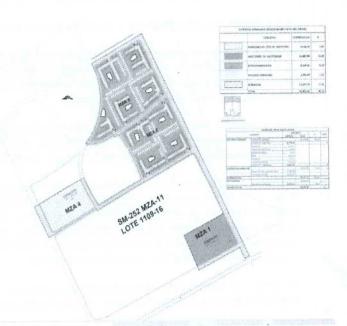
Distribución espacial de las áreas verdes donde se pretende reubicar las plantas rescatadas dentro del proyecto Nuevo Mayab.
